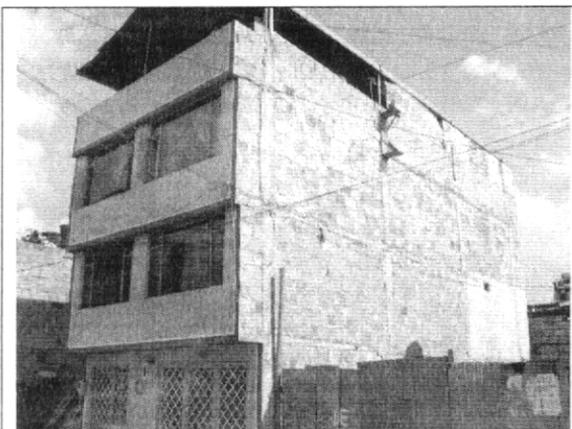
Construcción típica del desarrollo TORTIGUA, correspondiente a mampostería confinada.
